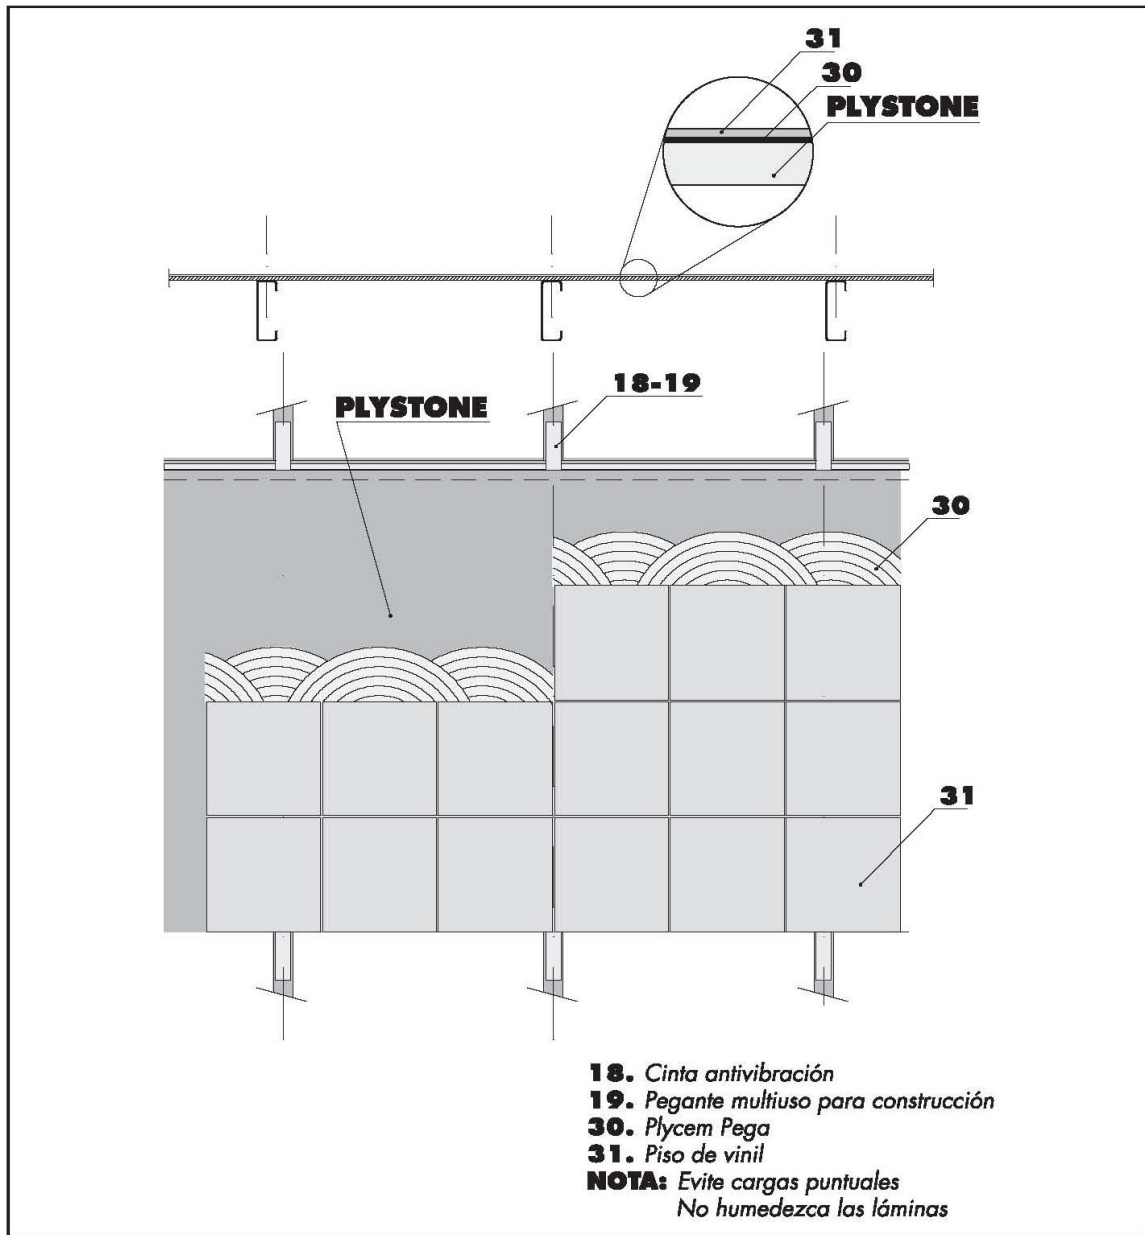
Detalle 5. Forjado. Acabados. Colocación de losetas de vinil [87].
